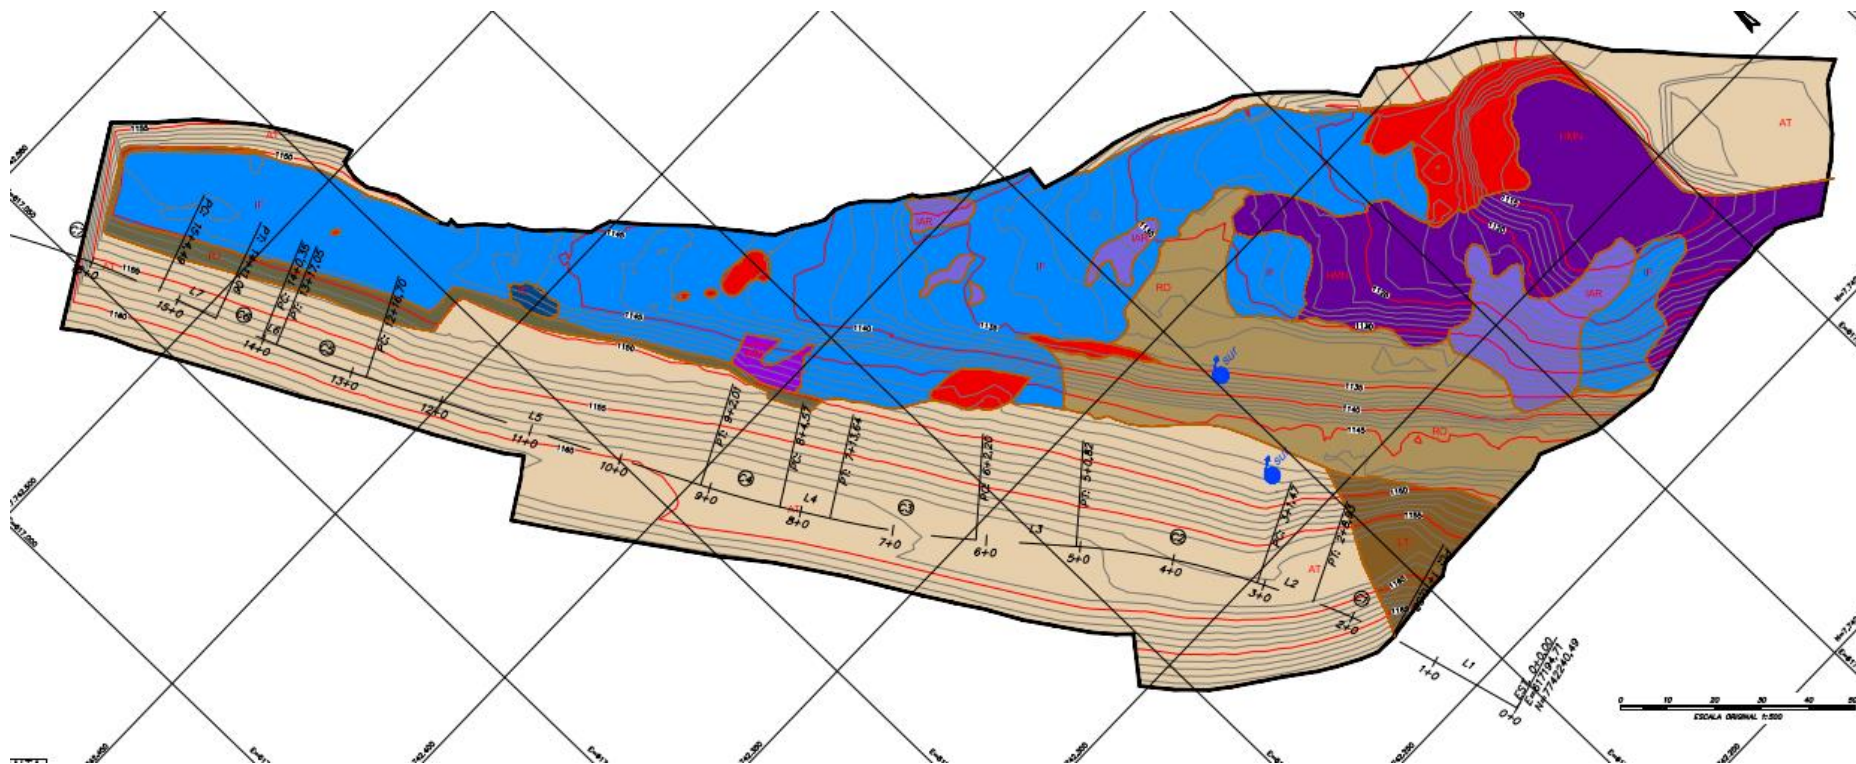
Planta do Mapa geológico-geotécnico da fundação do Reforço.
